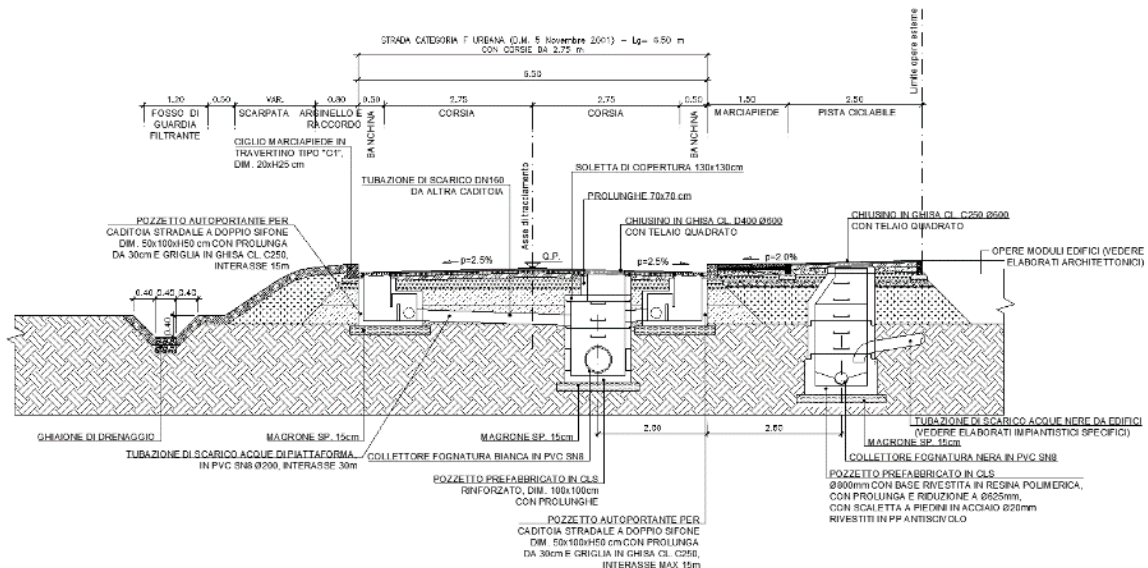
Sezione schematica stradale con reti di fognatura di progetto
